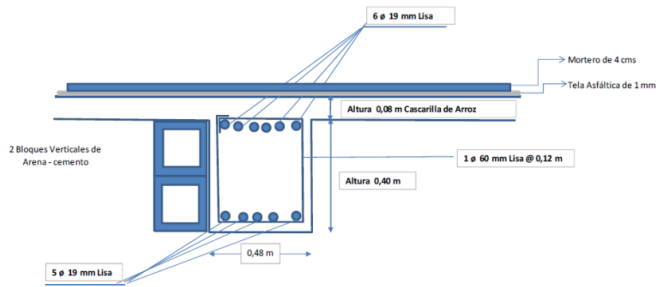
Viga 7 entre Ejes B-C Tercer Piso Segunda Placa
